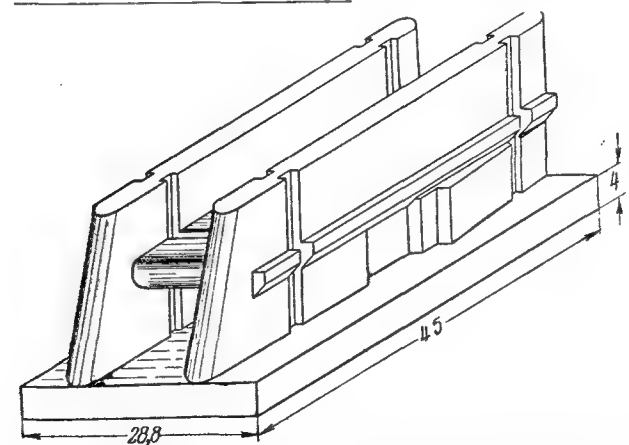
Общий вид наплавного агрегатного блока ПЭС.
